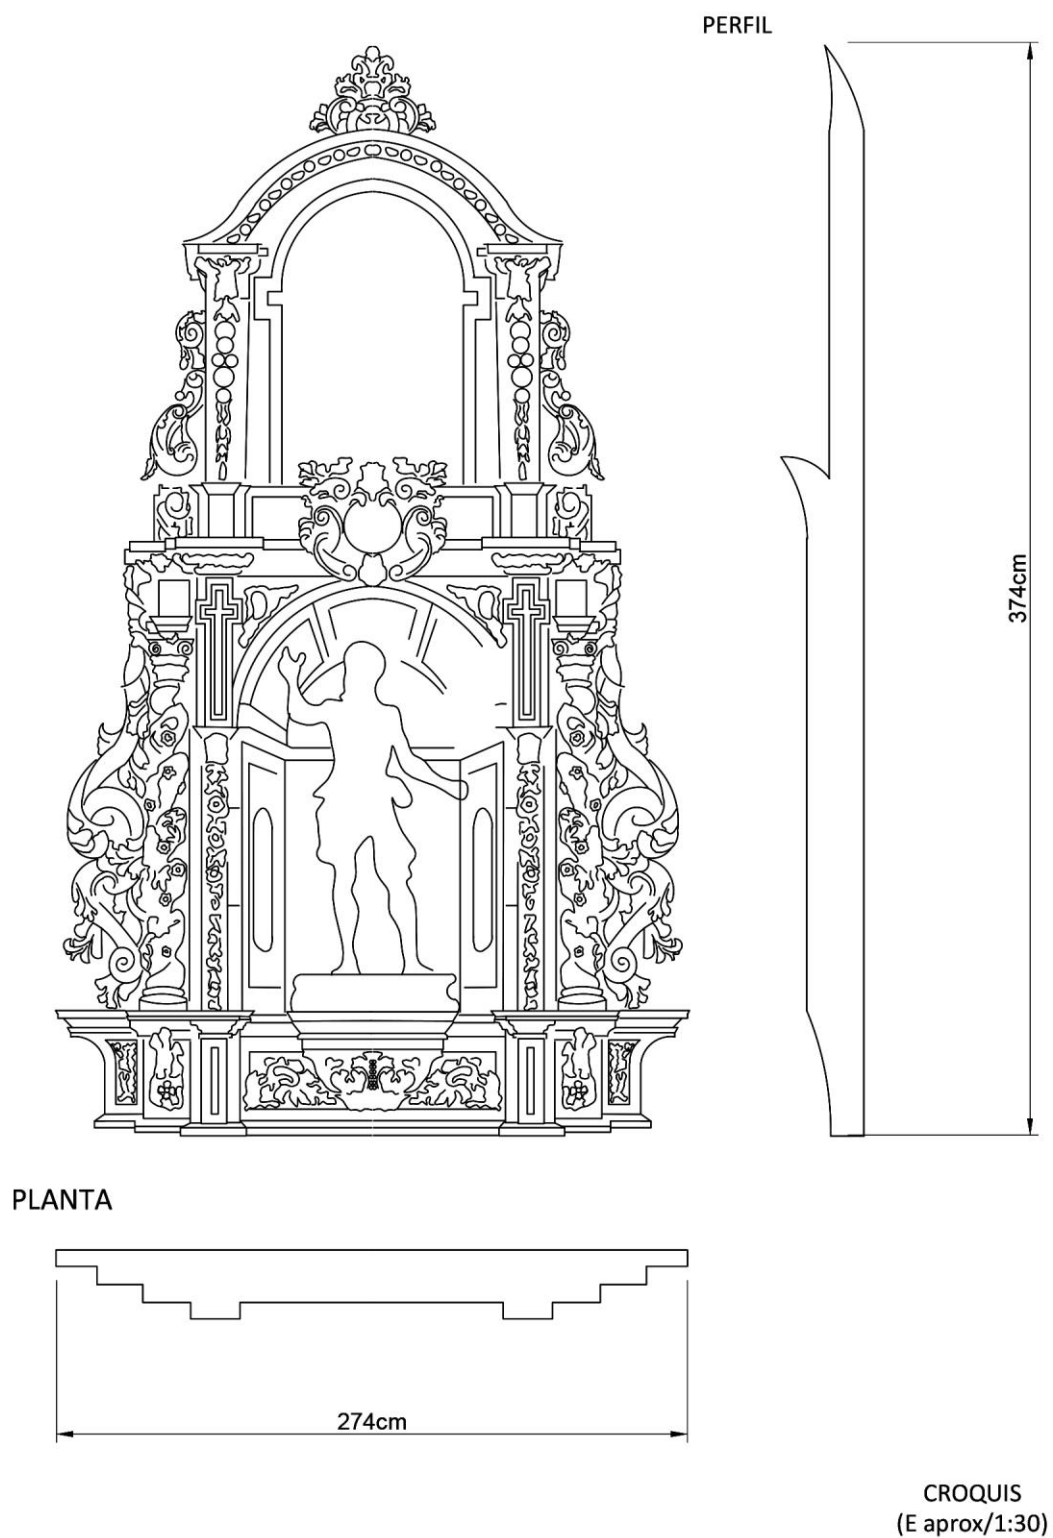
Plano de planta, perfil y alzado retablo de Cristo resucitado.
